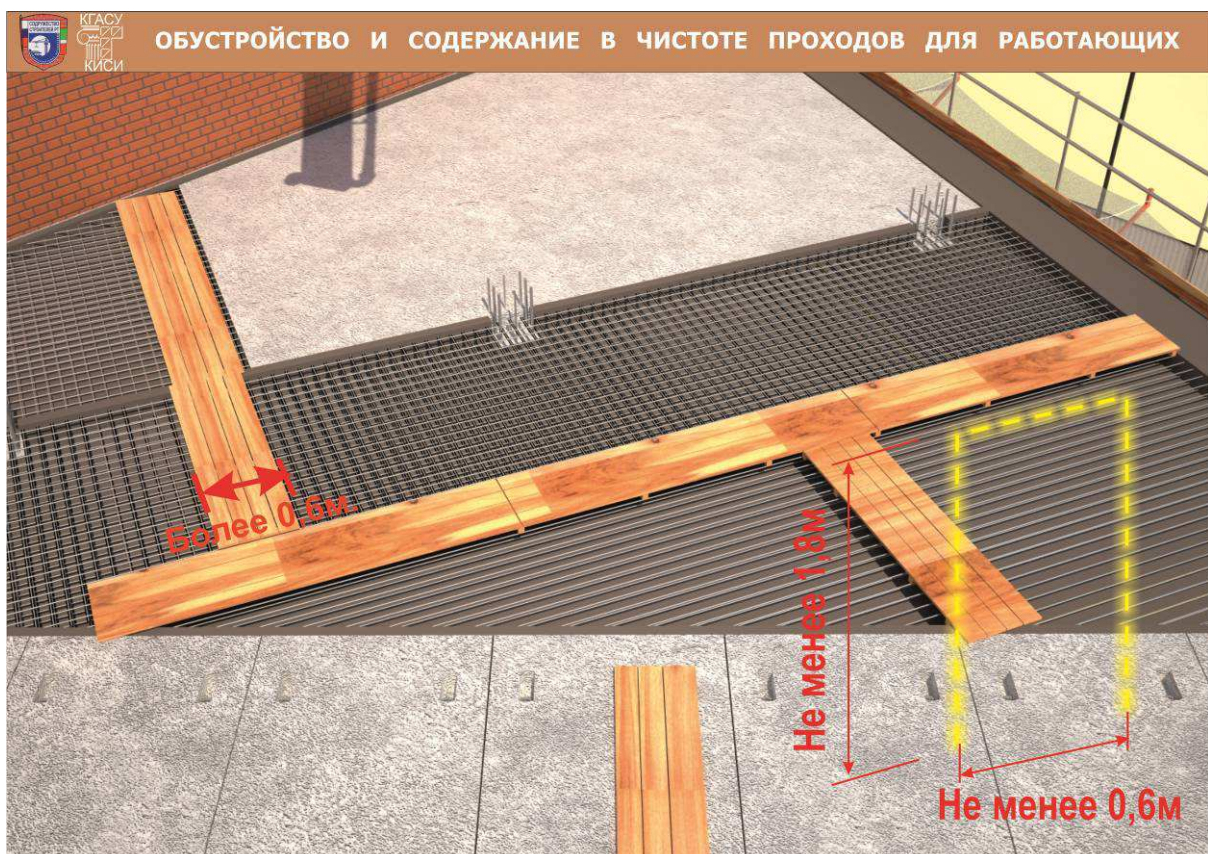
Организация проходов и рабочих мест из деревянных настилов по арматурному каркасу
